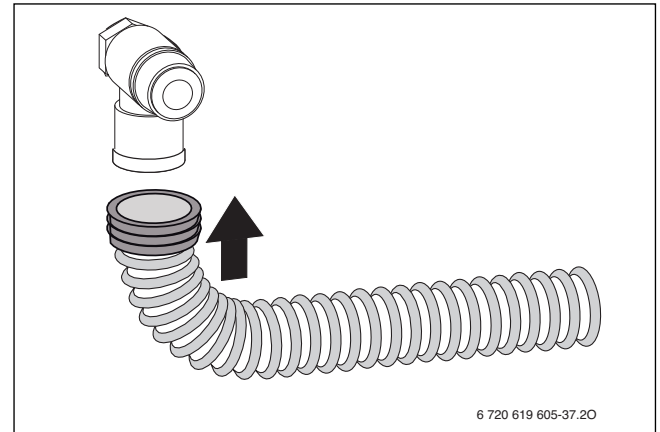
Montaggio del tubo flessibile sulla valvola di sicurezza
